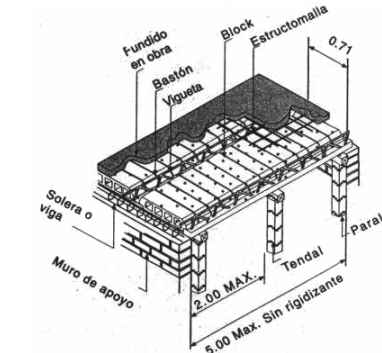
Losa prefabricada. Fuente: PRECON
